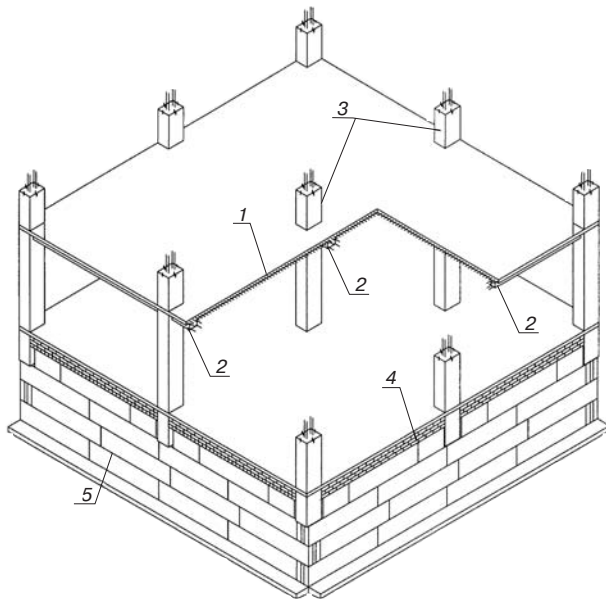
Конструкция каркаса индивидуального жилого дома: 1 – монолитная плита; 2 – несущие монолитные ригели; 3 – кирпично-бетонные столбы; 4, 5 – наружное стеновое ограждение
